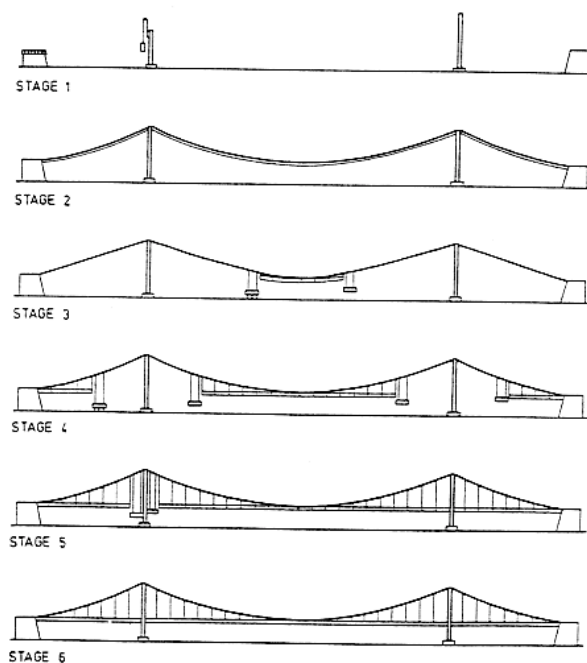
Fases construtivas do método “Girder section” (Gimsing (1997))
